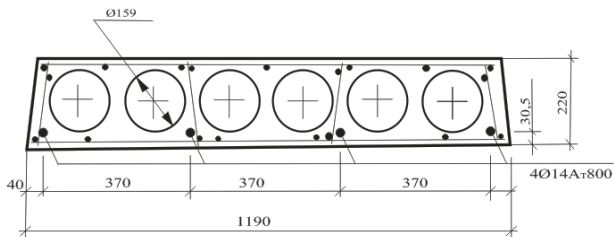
Армирование опытных предварительно напряженных плит из керамзитобетона на многокомпонентном вяжущем.
